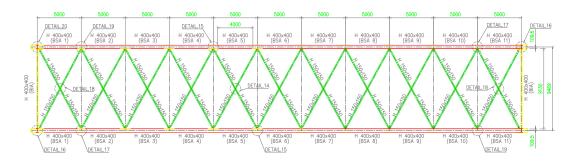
Dimensi Samping Perencanaan Jembatan Sei Rakyat
